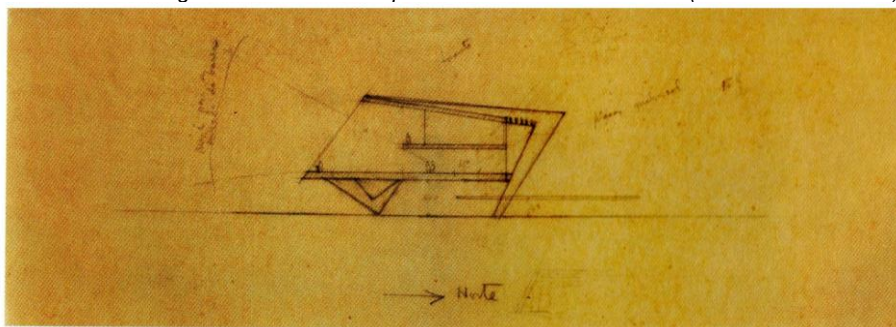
MAM-Rio. Croquis da fachada. (Fonte: Bonduki 2000).
